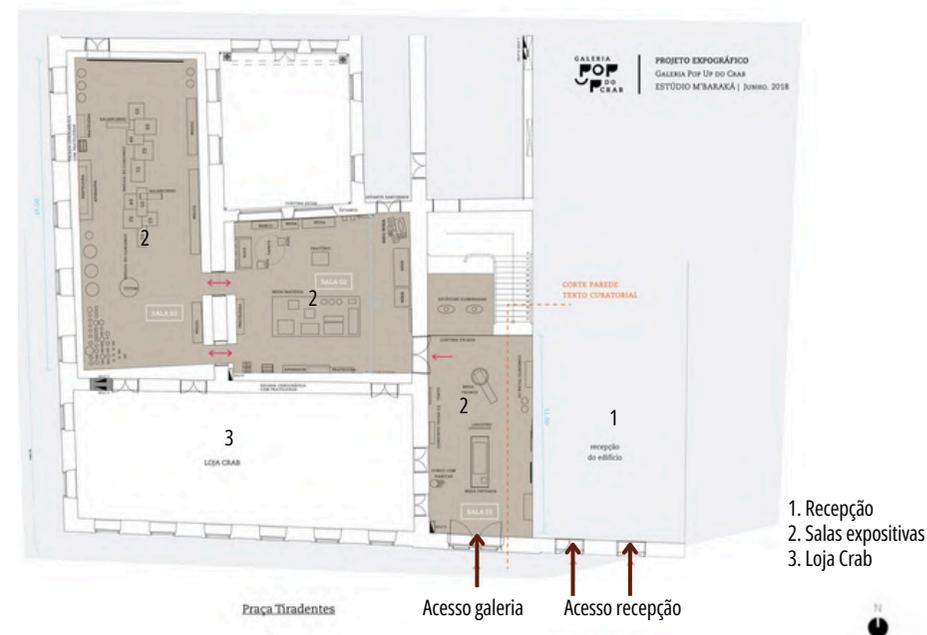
Planta baixa térreo editado por Autor 2025- Galeria Pop Up do Crab e Mideateca
